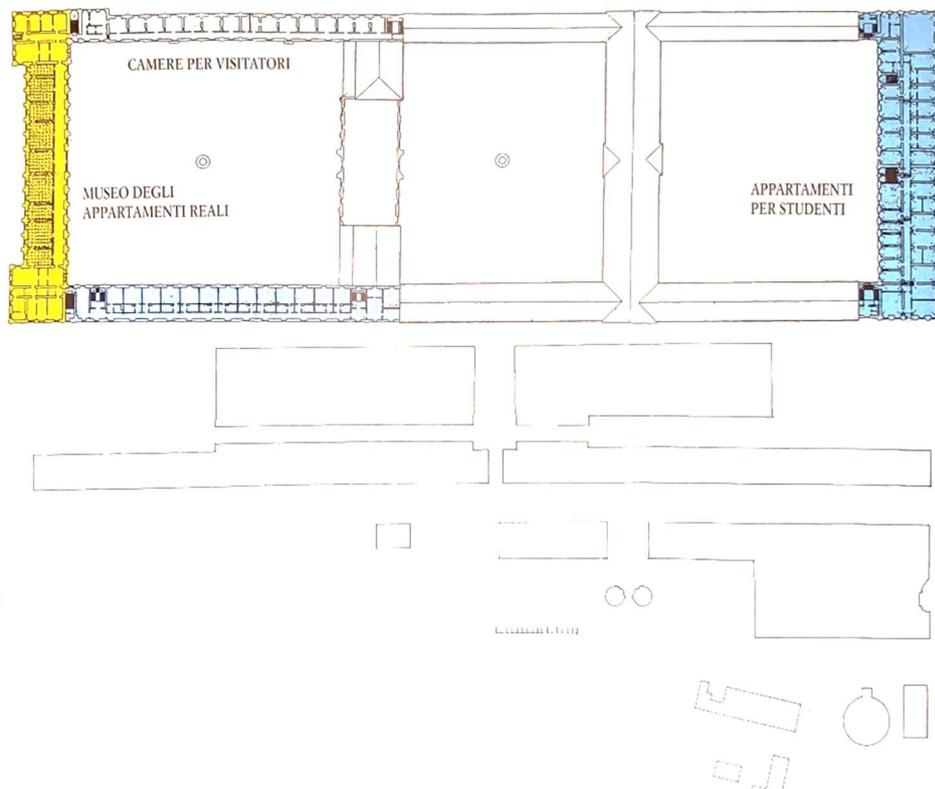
Complesso di Borgo Castello. Pianta piano secondo. Estratto
